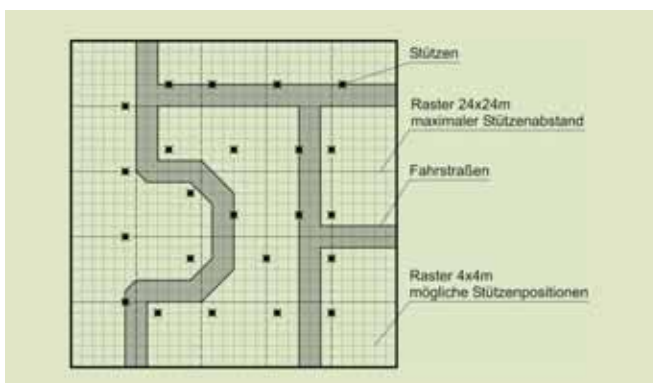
Grundriss der Fertigungshalle mit einer möglichen Stützenkonfiguration
